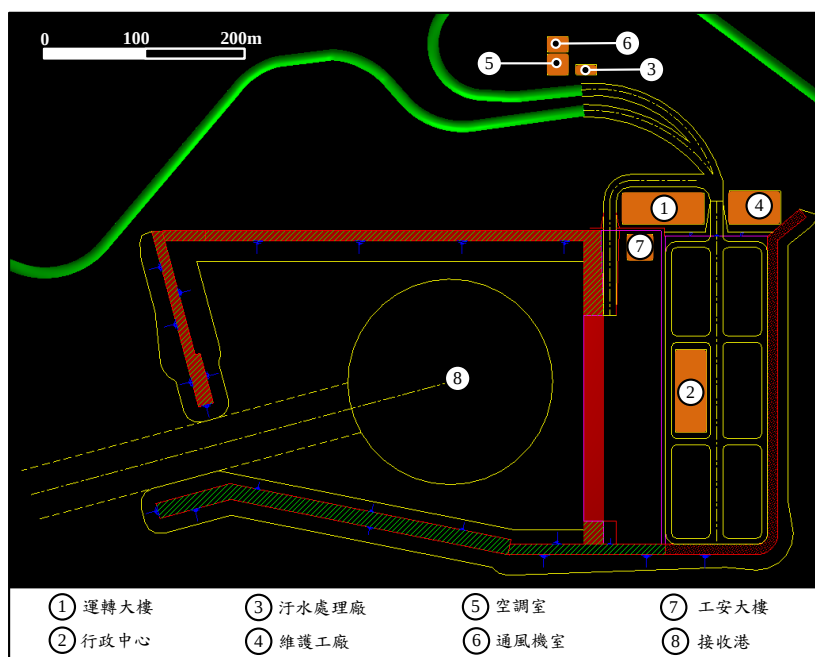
烏坵鄉建議候選場址輔助區平面布置圖
